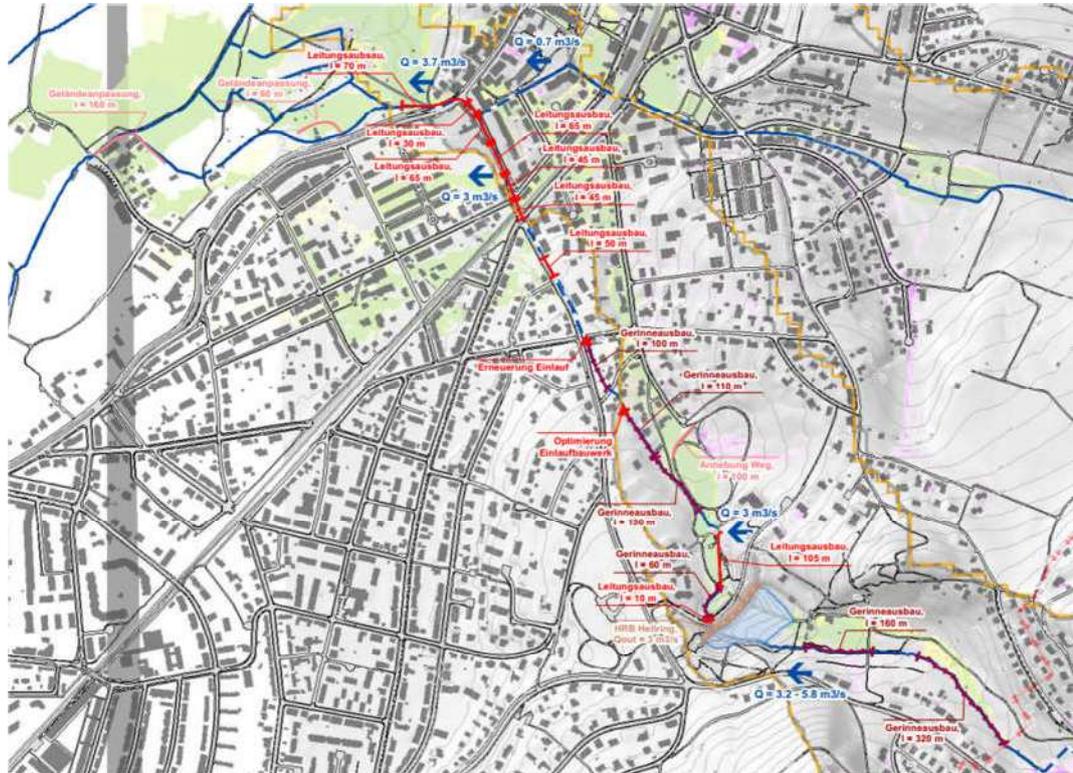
Ausschnitt aus dem Situationsplan Variante 3
